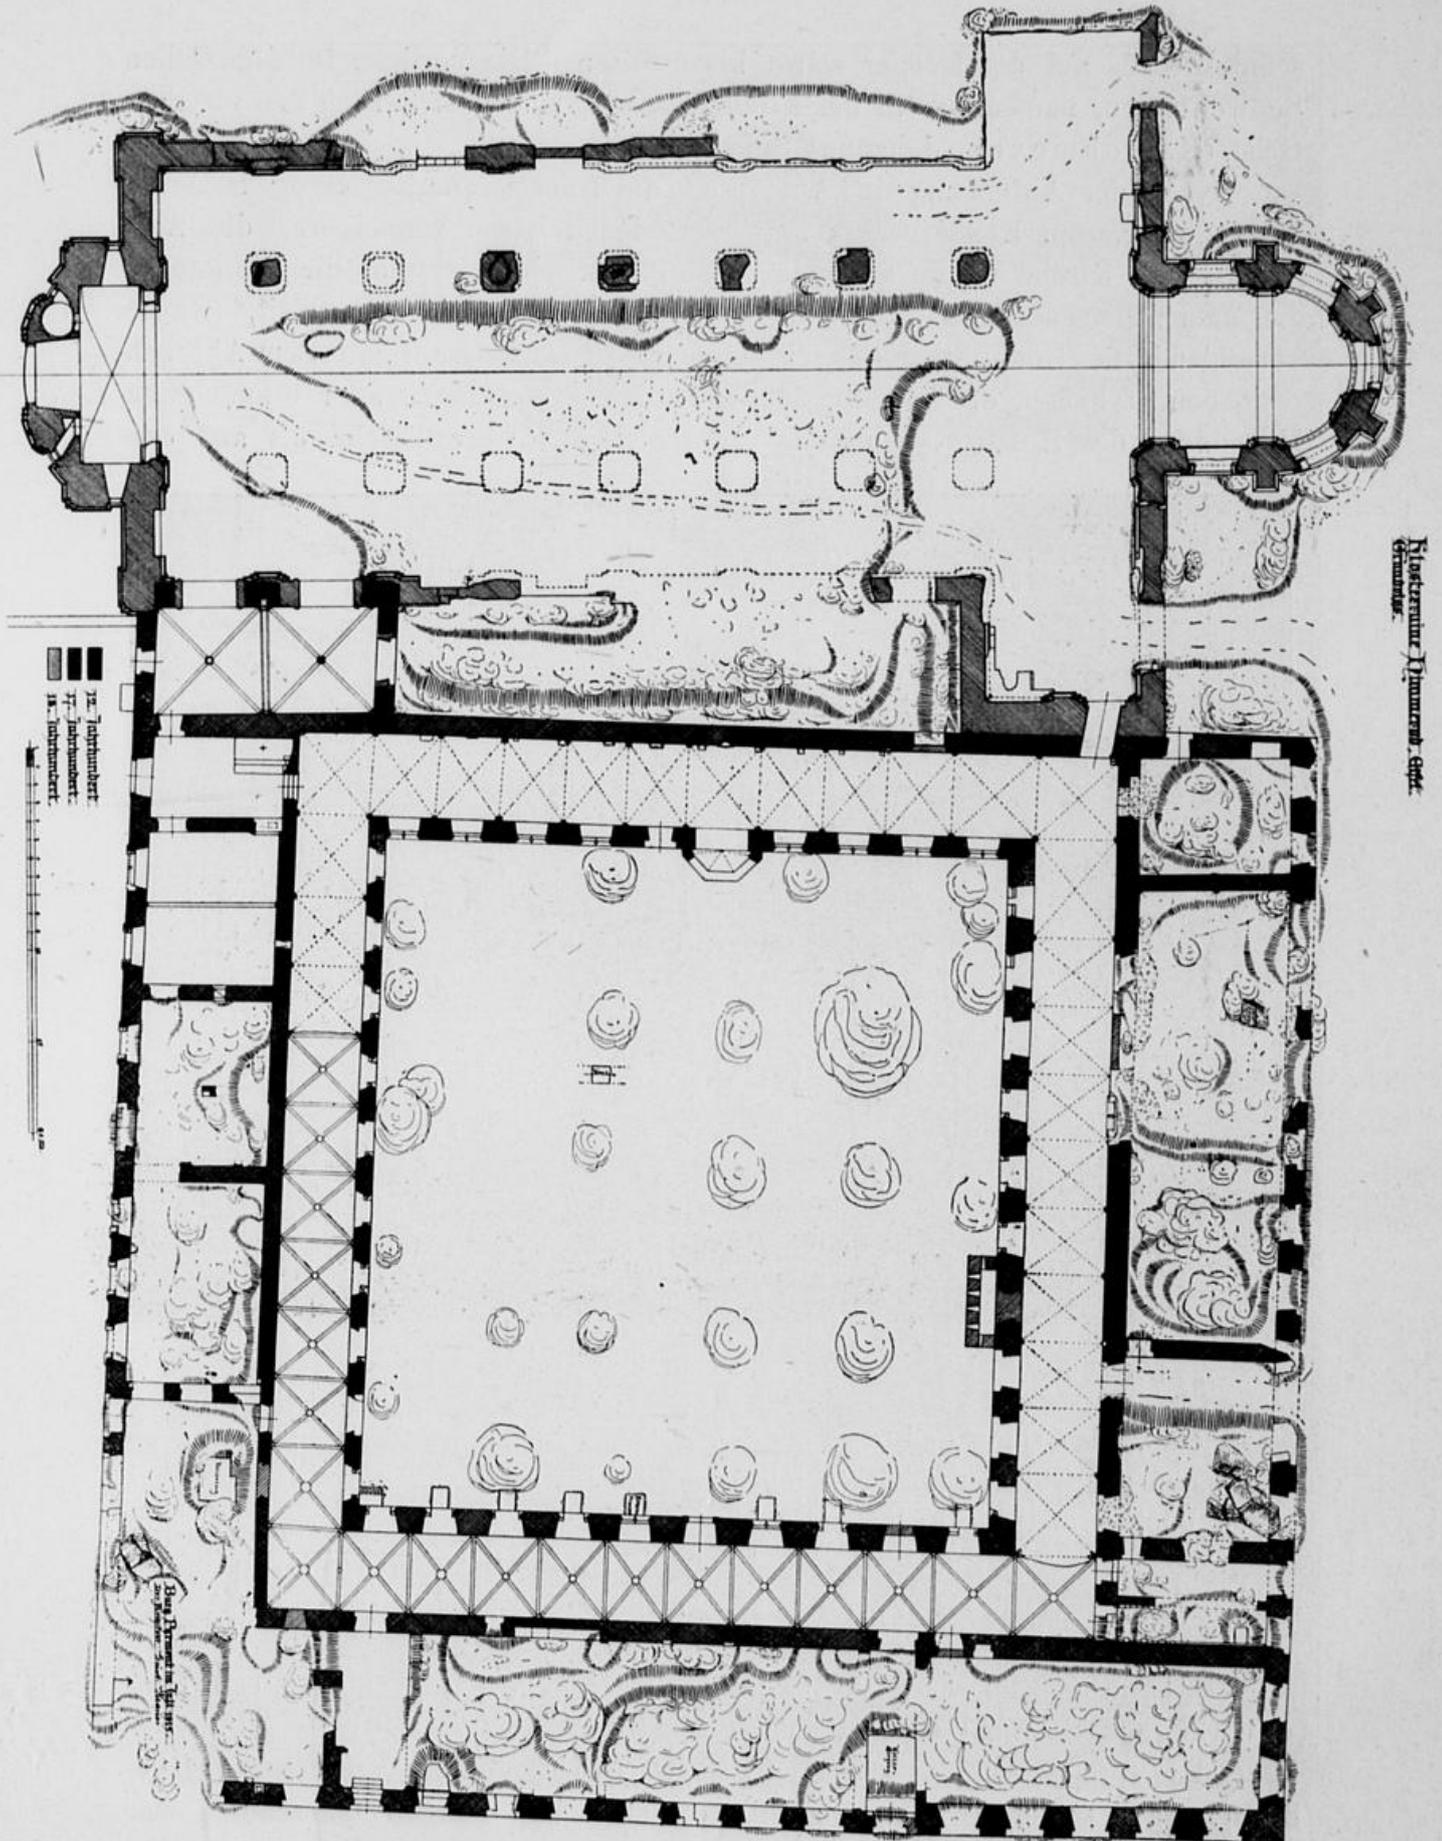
Himmerod. Grundriss von Kirche und Kloster.
